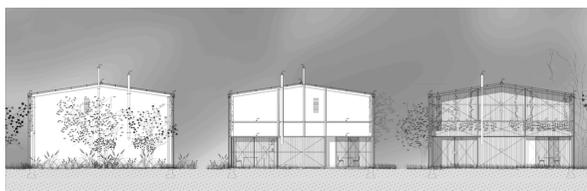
Fachadas transversales. Fuente: elaboración propia.
